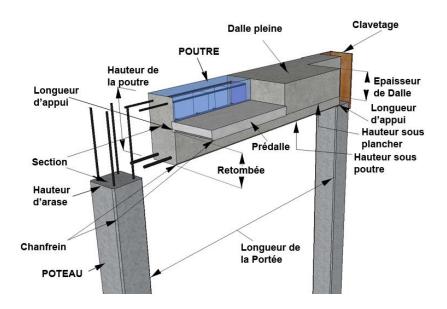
Détail d'une structure poteau poutre en béton armé.
